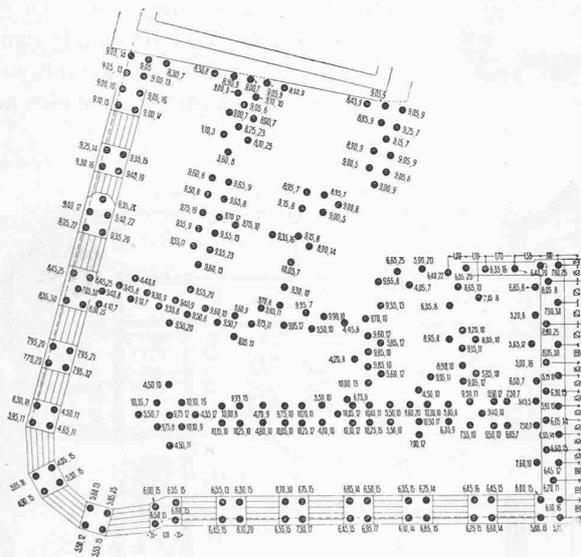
Fondations d'une maison de commerce, à St-Gall.
